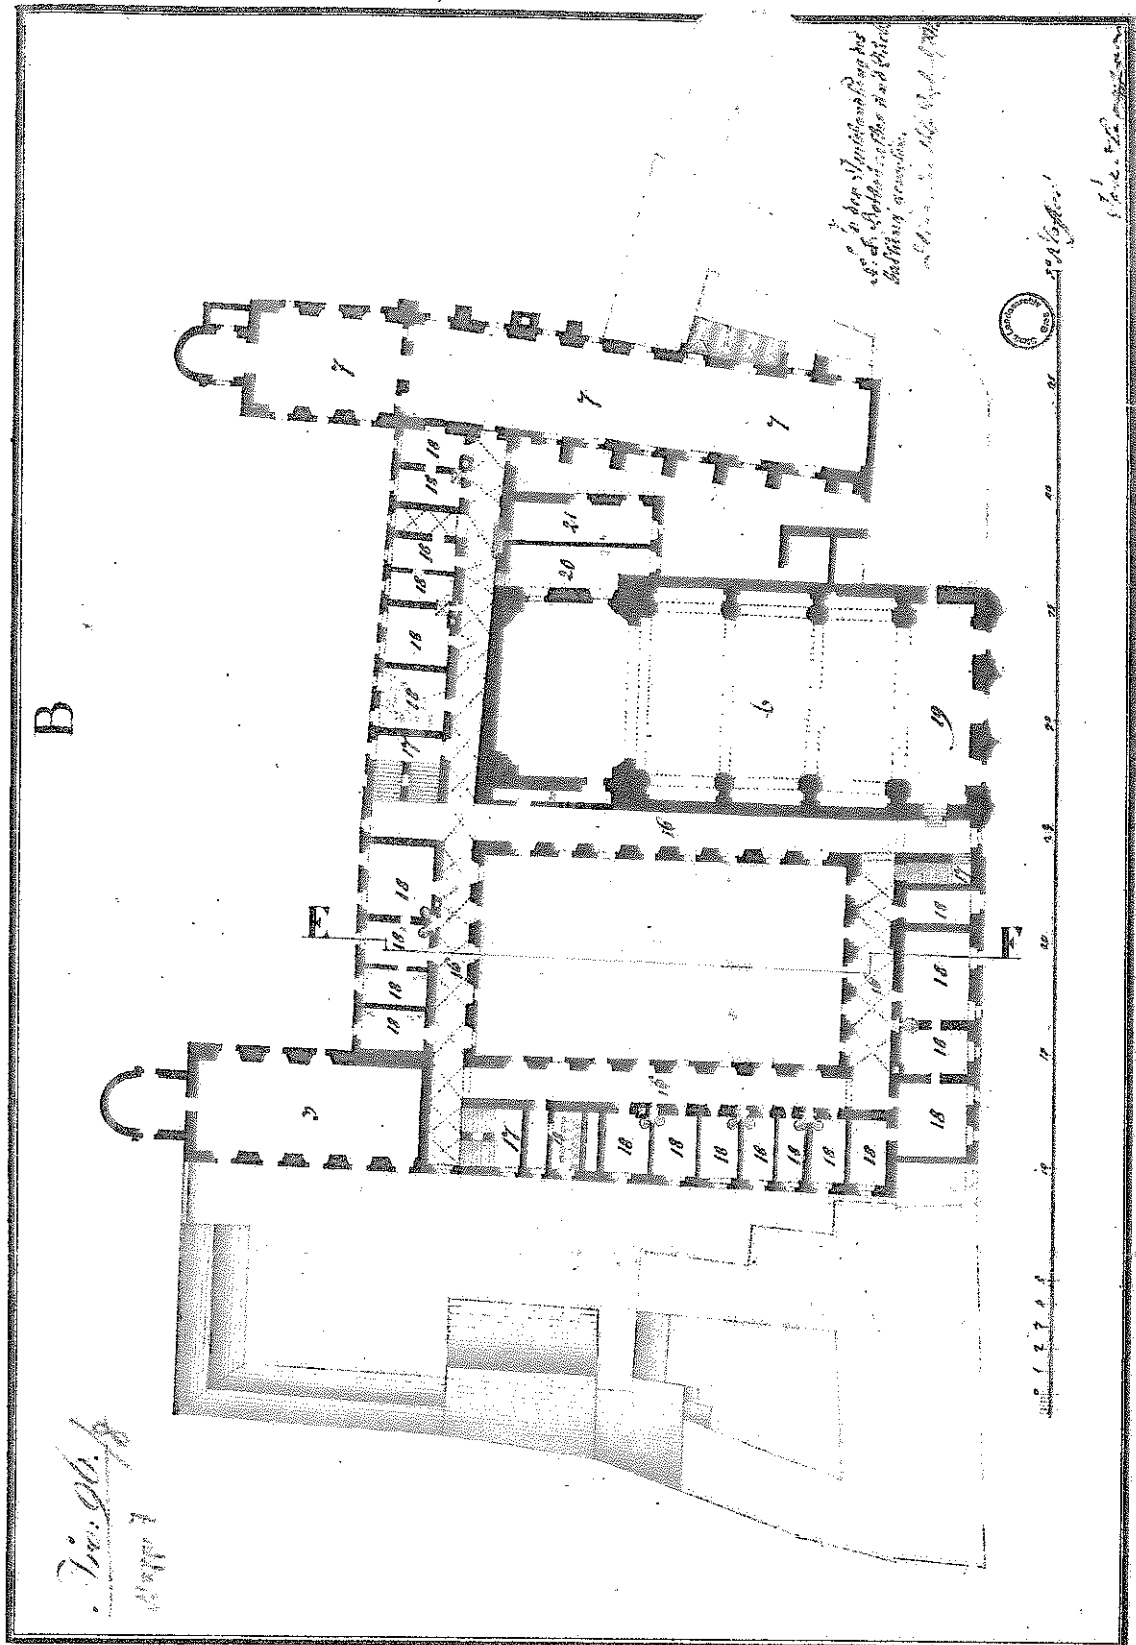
Christoph Stadler, Kloster und Spital der Barmherzigen Brüder mit Barmherzigenkirche, Zeichnung, um 1811, Grundriss 1. Obergeschoss.
